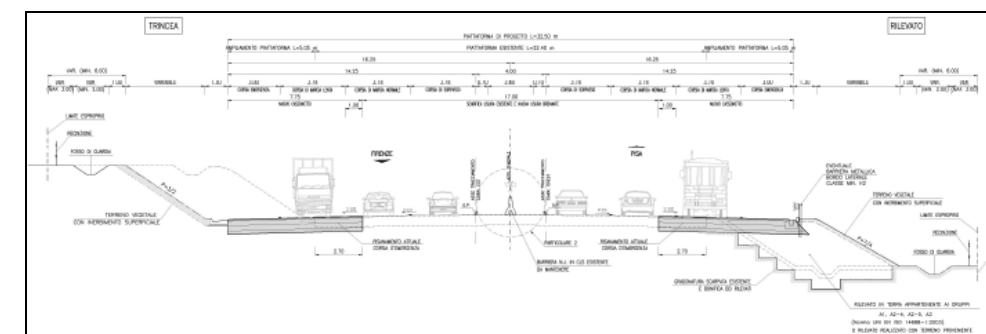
Sezione tipo in ampliamento simmetrico
